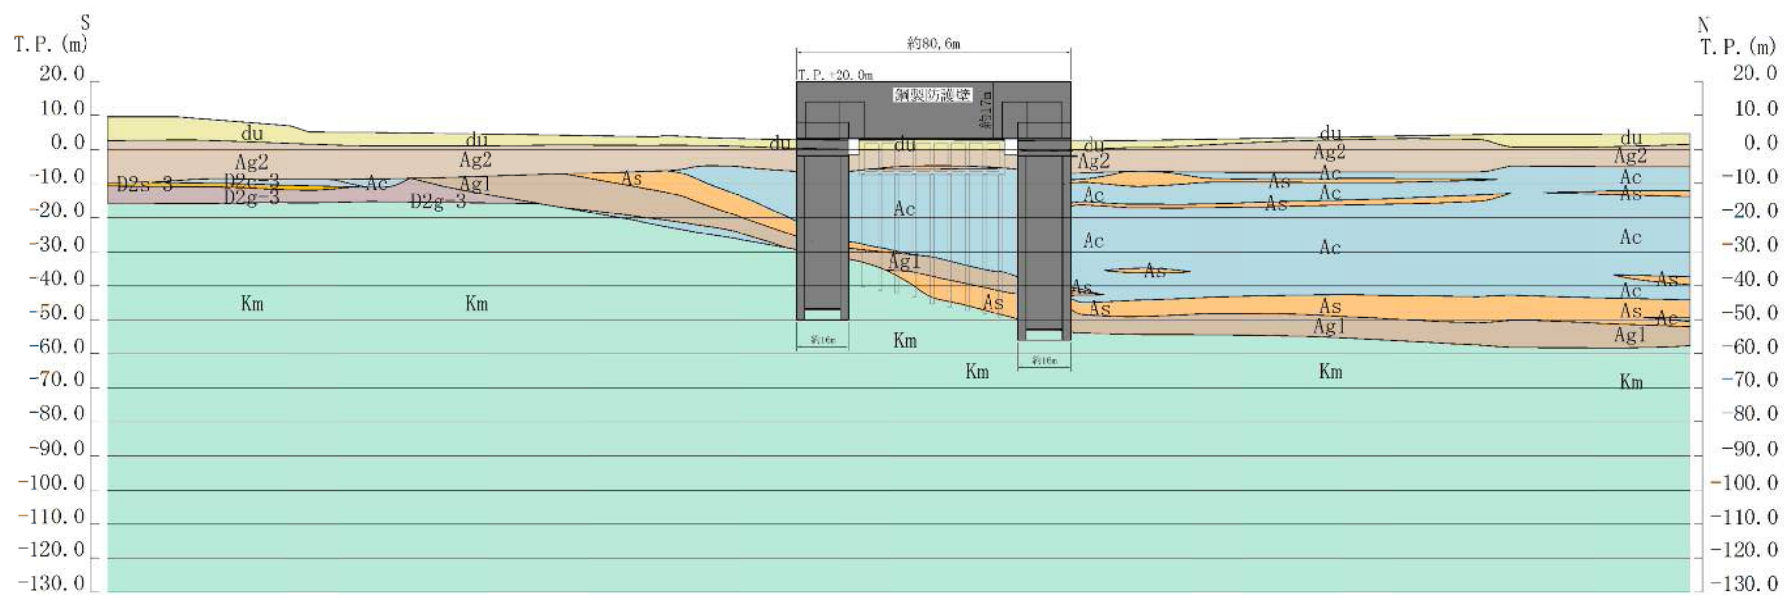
2 (1) 鋼製防護壁 断面図 (①—①断面)
